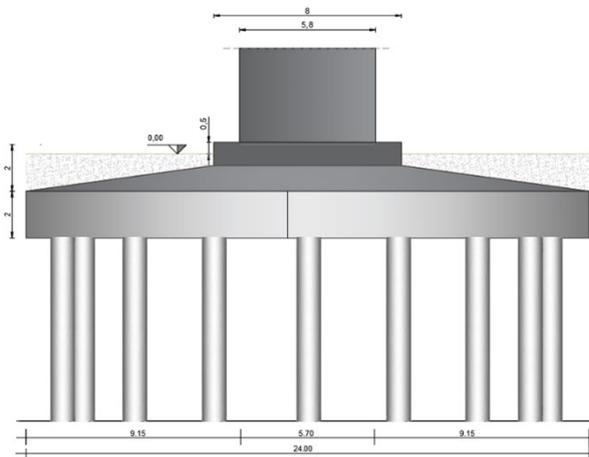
Schema geometrico di riferimento della struttura di fondazione
